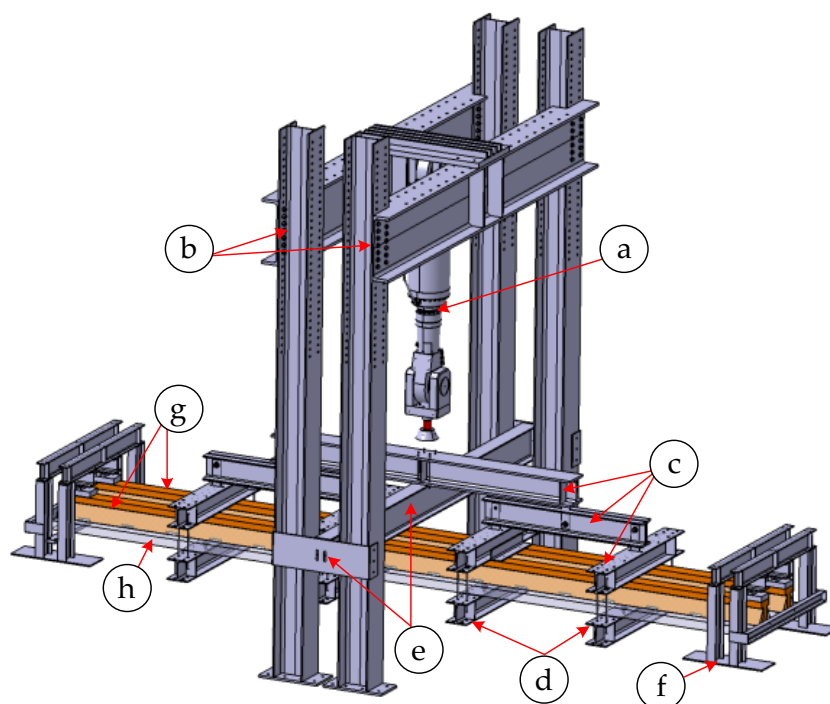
(a) Vérin hydraulique, (b) Portique, (c)-(d) Système de chargement, (e) Système de guidage, (f) Système d'appui, (g) Poutrelles en bois, (h) Dalle de béton.
